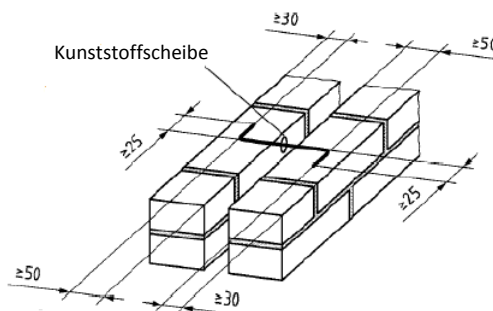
Drahtanker bei 2-schaligen Mauerwerk
